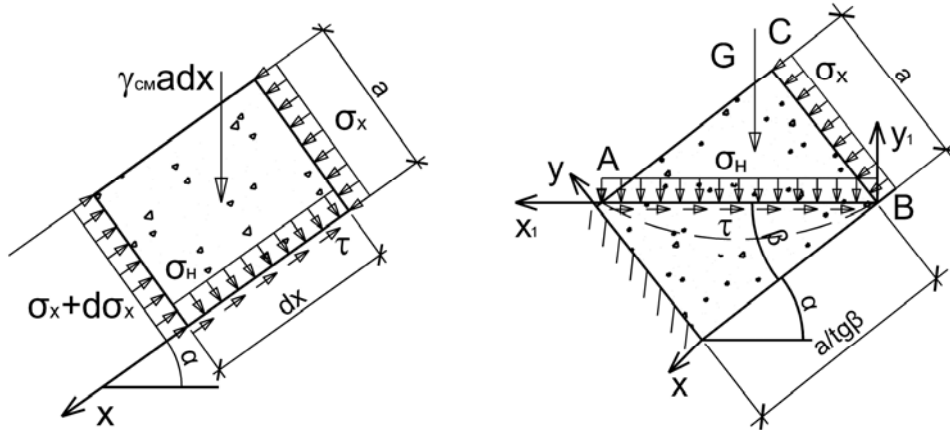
Расчетная схема по определению сдвига бетонной смеси в зоне бортовой опалубки
